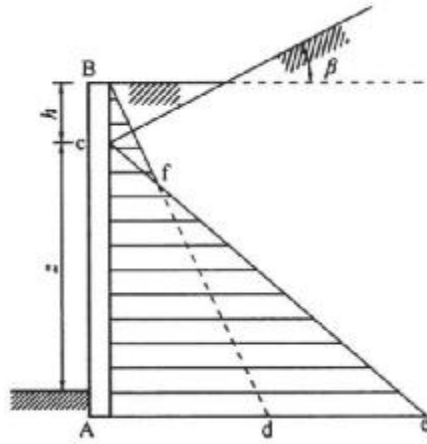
地面局部为水平时支护结构上主动土压力的近似计算
